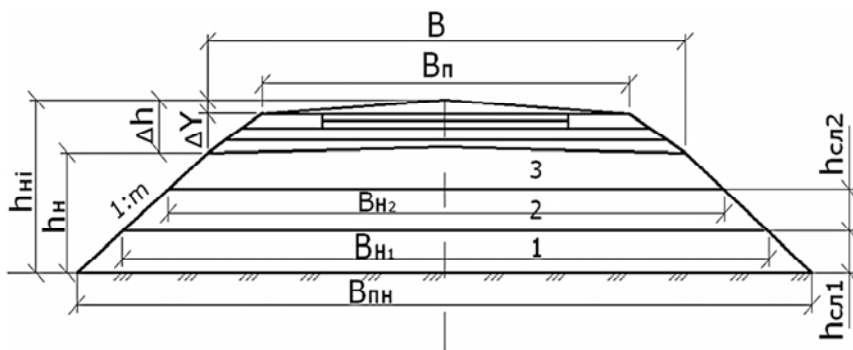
Схема расчета ширины верха земляного полотна при отсыпке отдельных слоев насыпи
